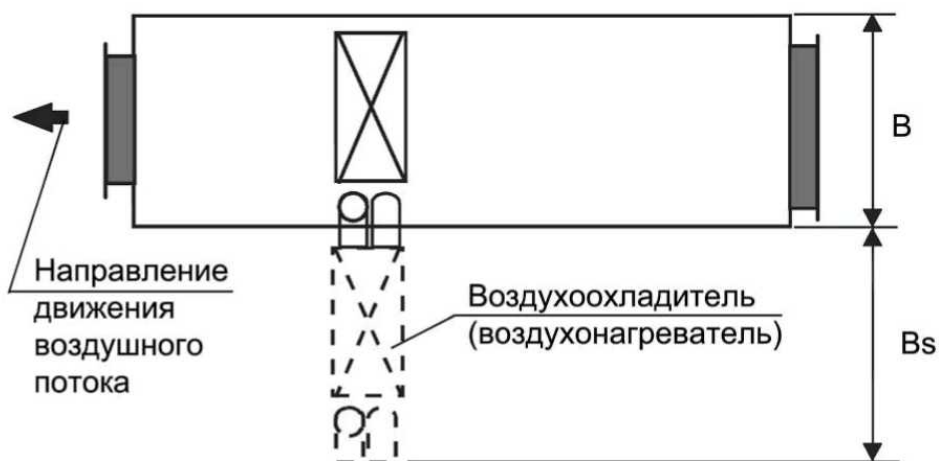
Определение зоны обслуживания вентиляционной установки
